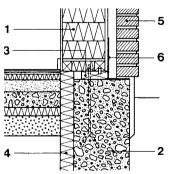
Detail 3, 1:20. Lodret snit i samlingen fundamentlydervæg. 1. Vægelement, 235 mm. 2. Rendefundament af beton støbt på stedet. 3. Fodrem, 45 × 145 mm, trykimprægneret. 4. Kantisolering, 75 mm. 5. Skalmur. 6. Asfaltpap.
